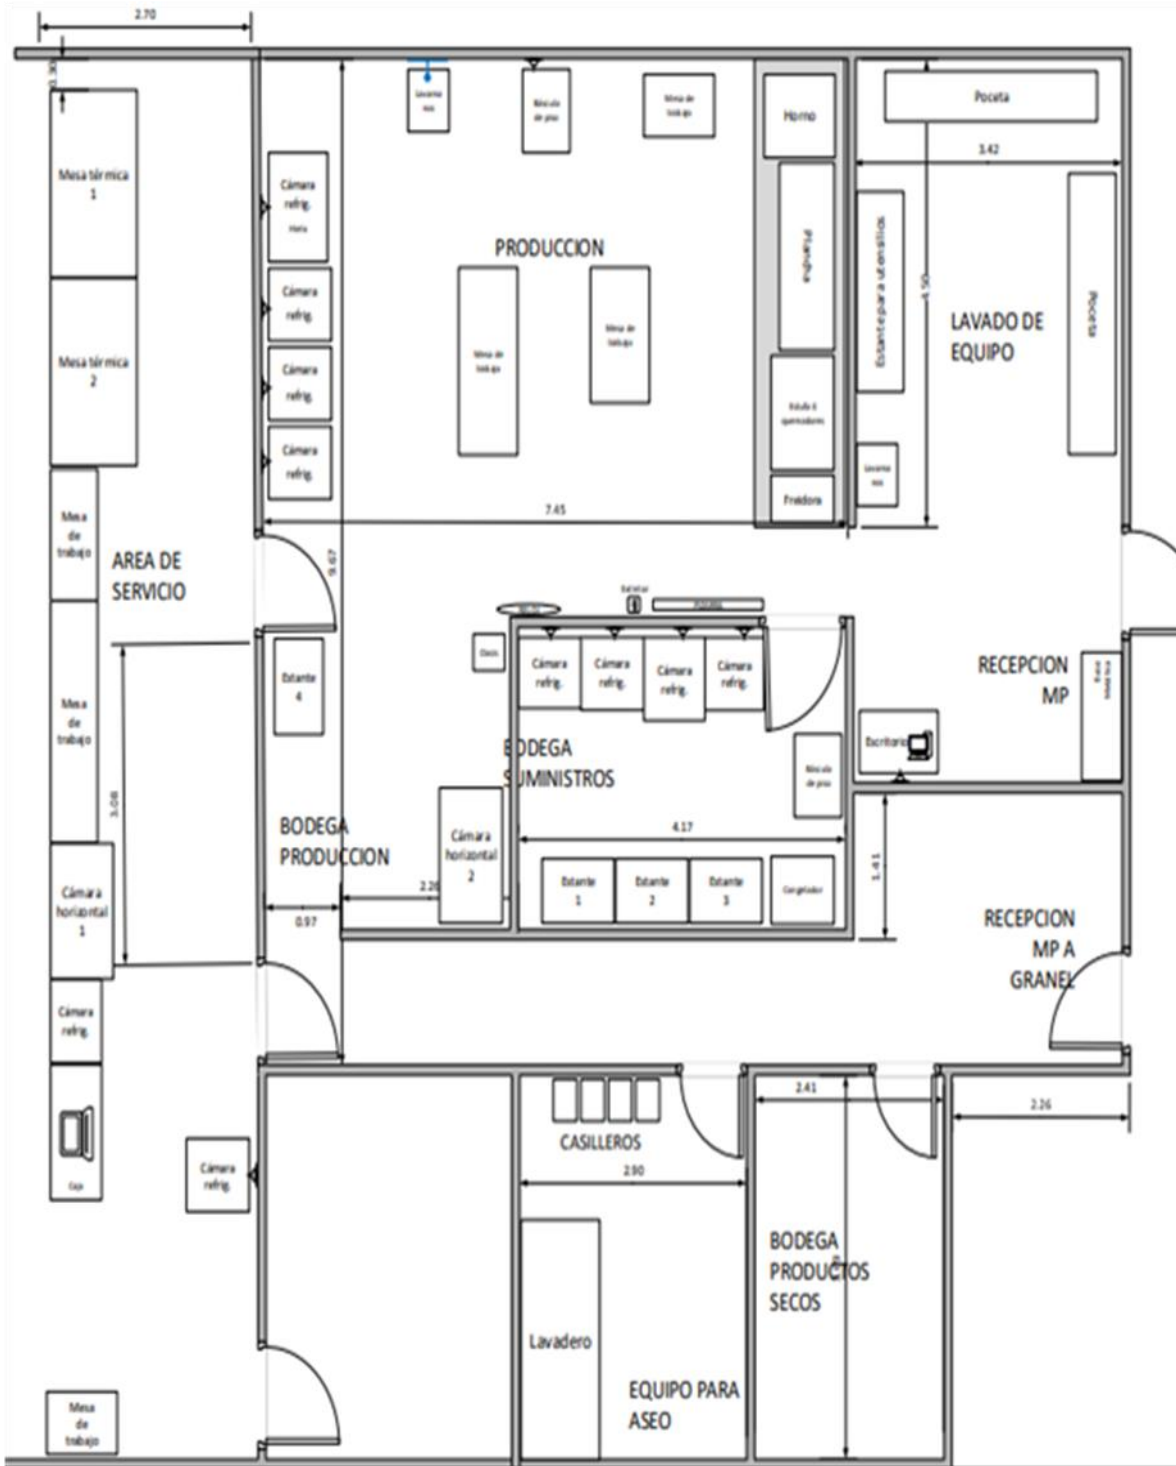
Distribución en planta de cafetería industrial Pettenati
